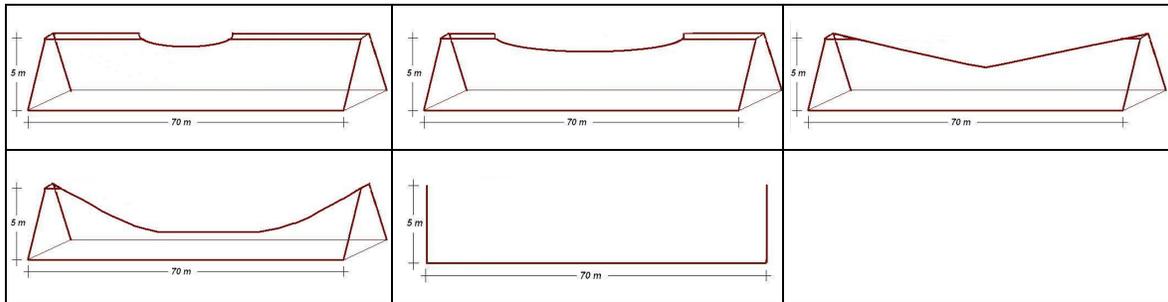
Modificación de la sección de la falla en el bordo (parte central del presón)
